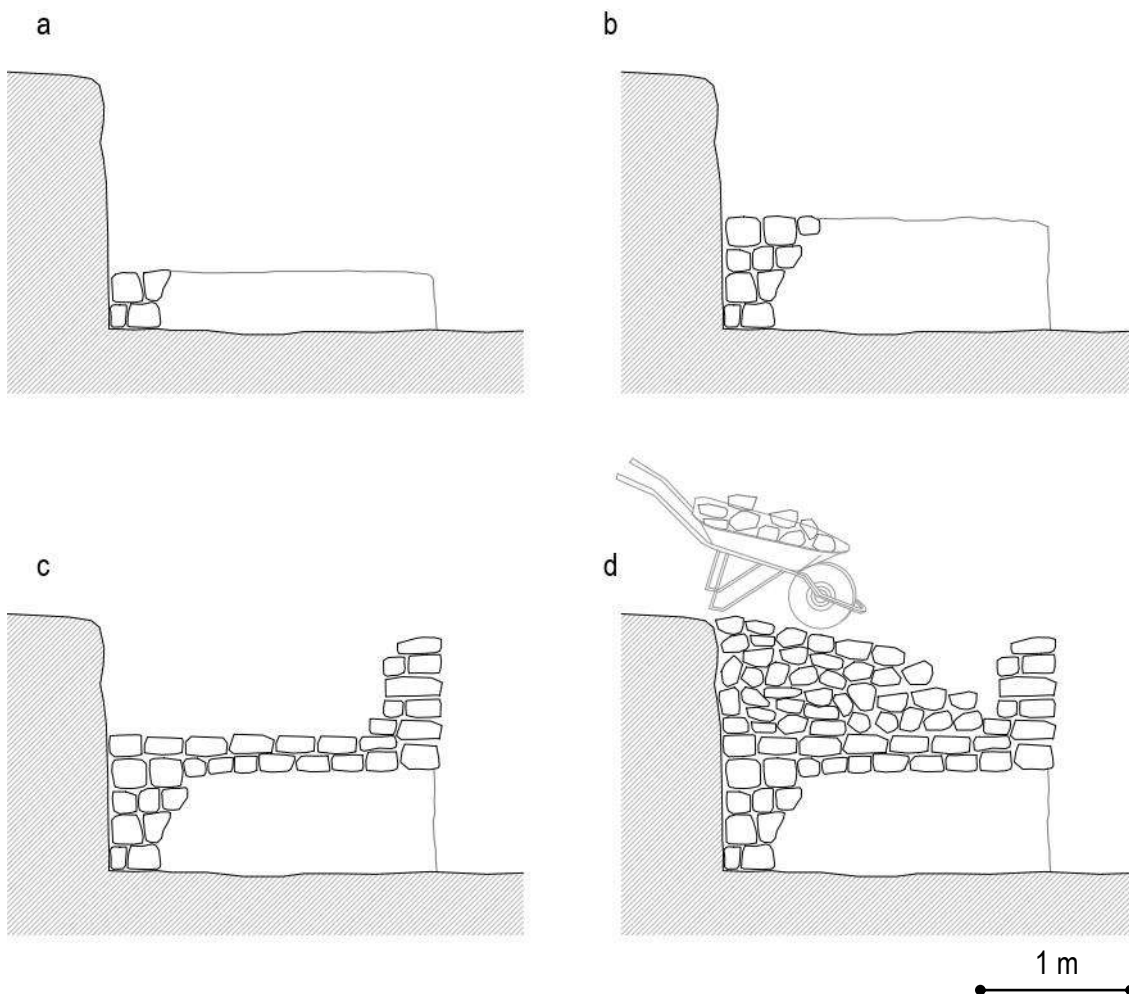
Proceso de construcción del horno de Albarracín con hiladas para realizar la bóveda: a) y b) técnica de aproximación de hiladas hasta completar la bóveda; c) colocación de dos capas de piedra estables y levantamiento de murete en la parte frontal; d) carga del horno desde la parte superior. Elaboración propia.
